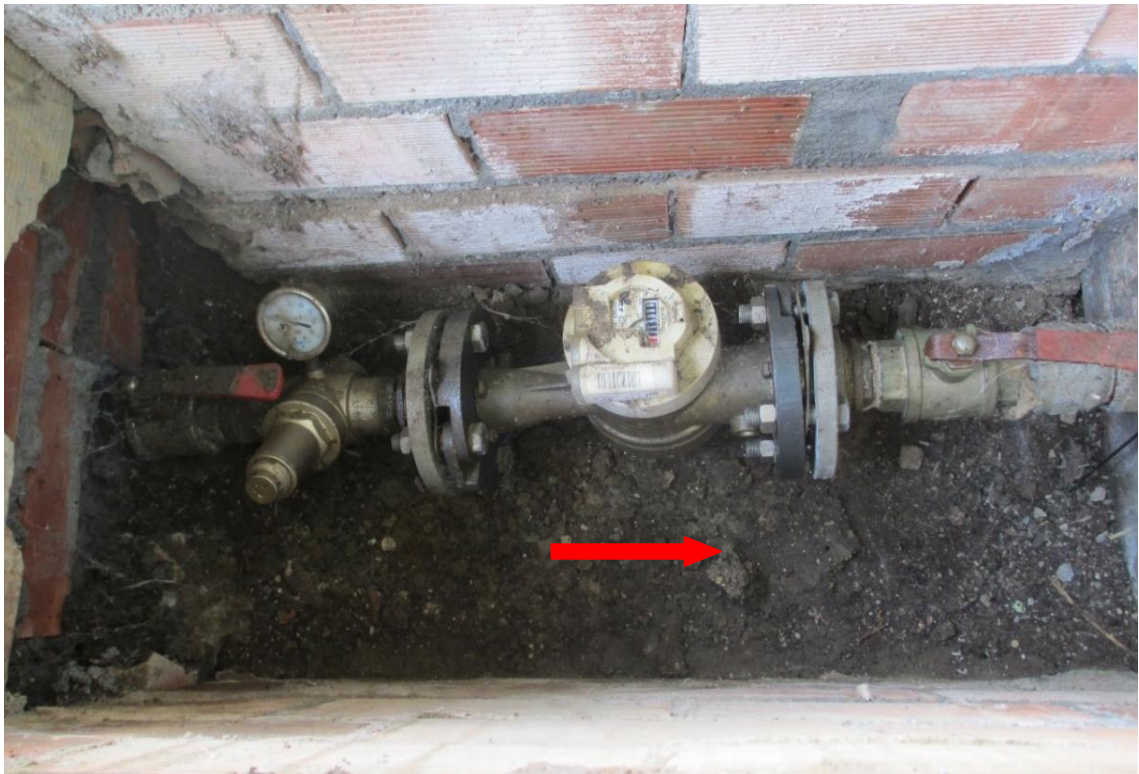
Foto de la instalación original del contador en A27 (Colegio), Z.
